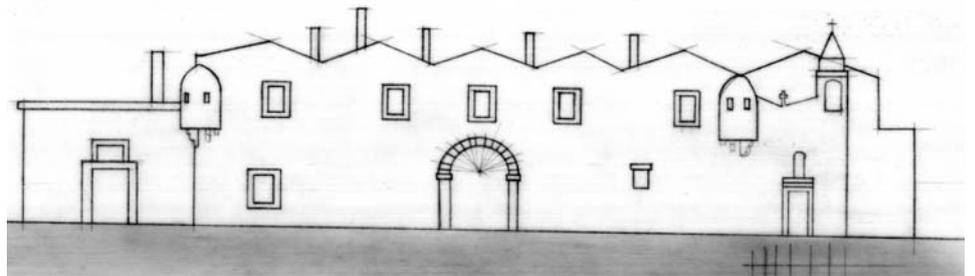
46: Masseria Viglione - Prospetto principale e laterale
